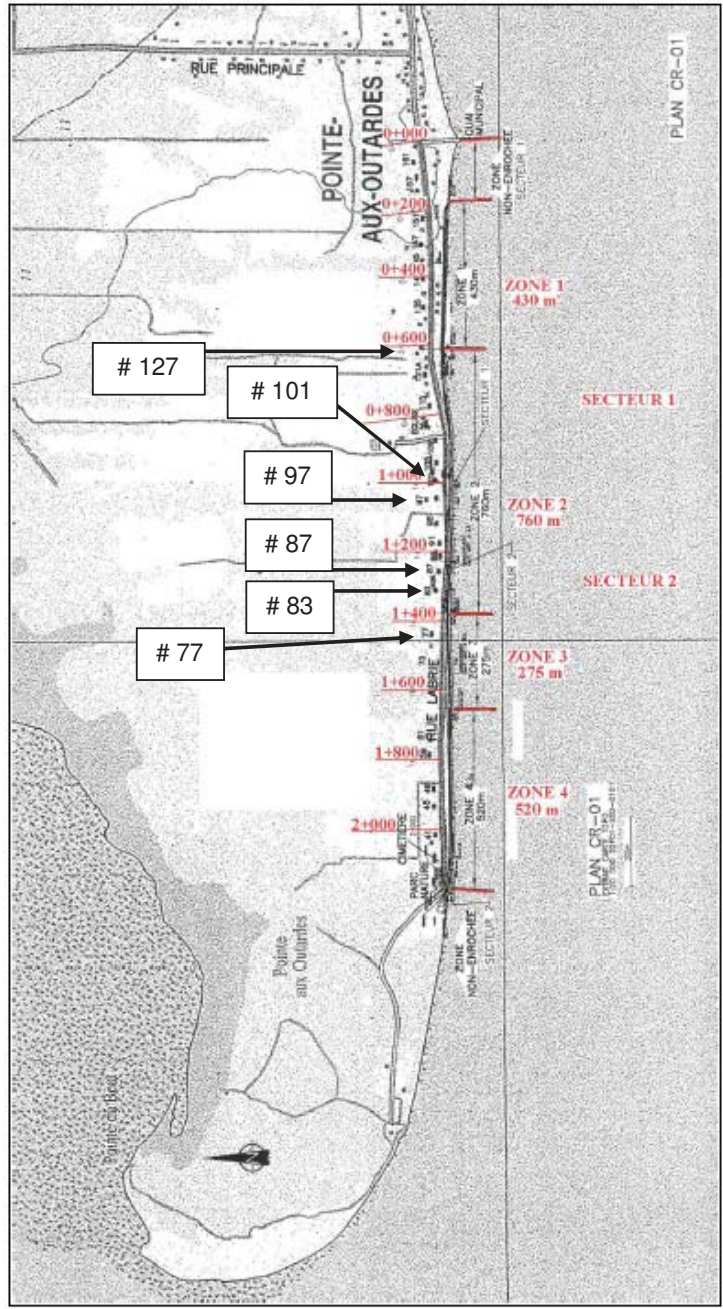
Plan CR-01 – Groupe-conseil TDA 2011.
